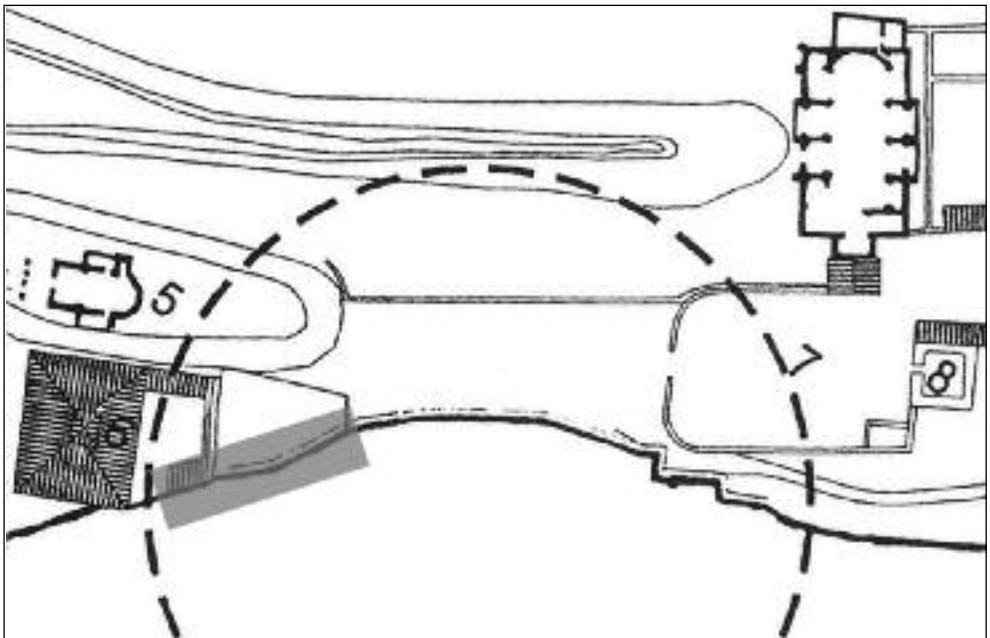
Plano de situación del área arqueológica intervenida en 2011 (franja gris). 5: ermita de San Juan, 6: Museo, 7: cementerio, 8: torre de Doña Blanca. Sobre planimetría del proyecto de restauración, de la Fundación Santa María de Albarracín/Pedro Ponce de León.
